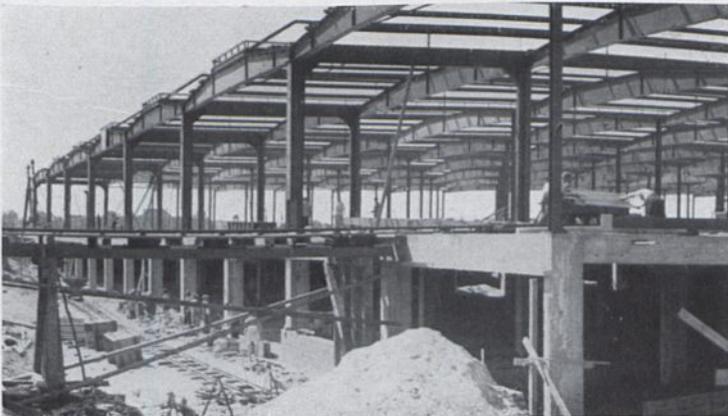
Die Stahlkonstruktion der Hallen nach beendeter Montage.
